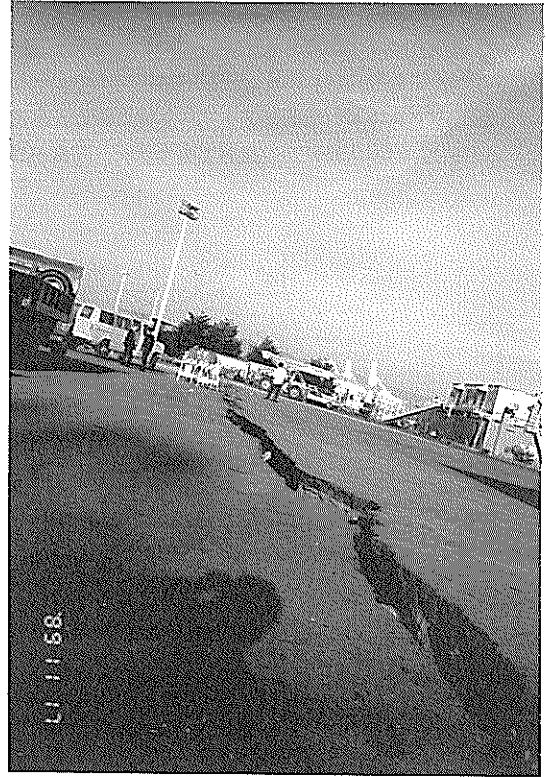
7th Street ターミナルのクラック、地盤沈下 (バース40)
